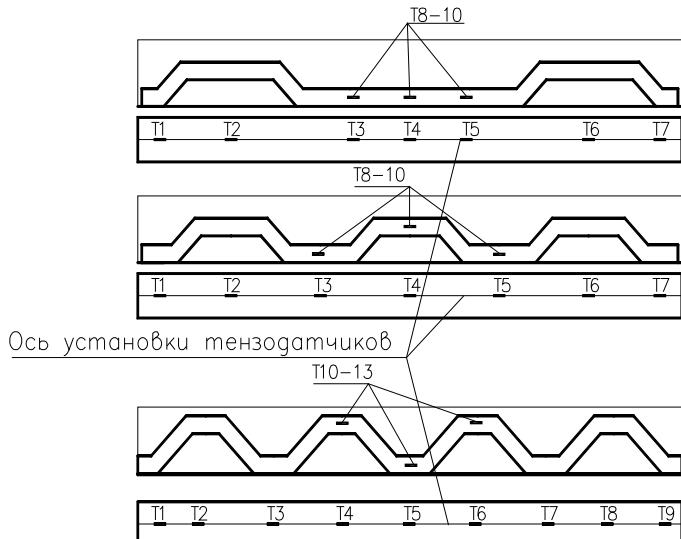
Схема расположения тензорезисторов на стальном, сварном каркасе опытных образцов
